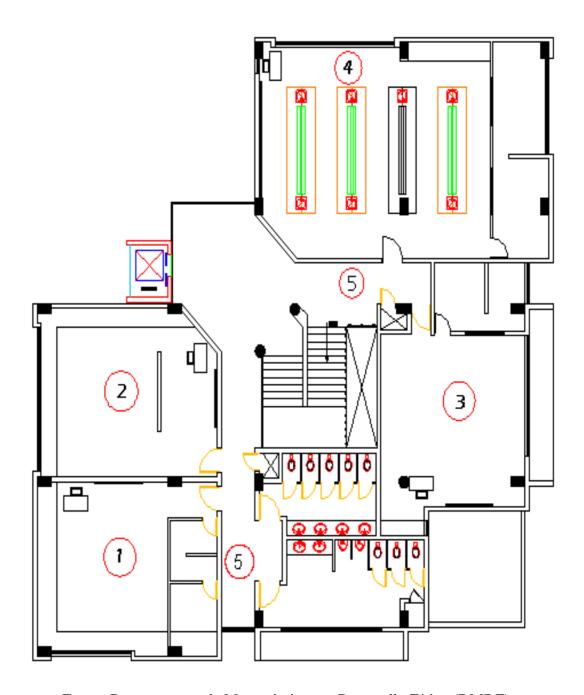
Plano planta baja edificio de laboratorios de la Facultad de Mecánica
